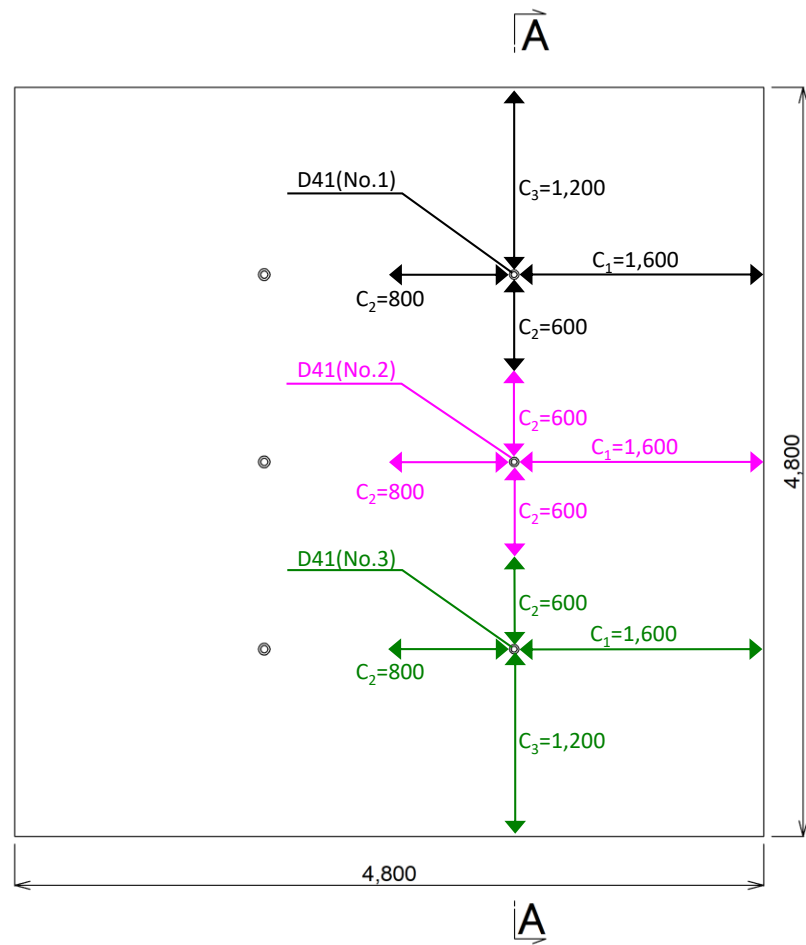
(3) 実験体の構造図* (供試体①の平面図)
